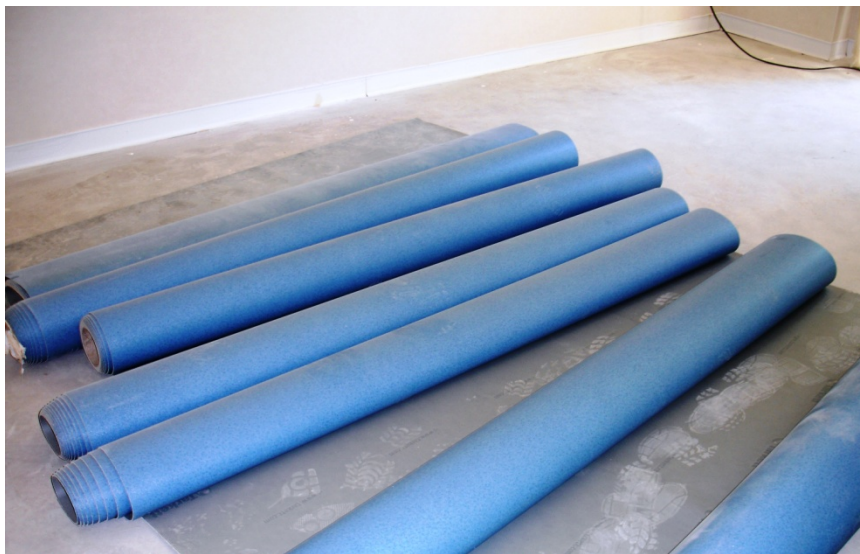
Material vinílico cortado e armazenado antes da sua aplicação
